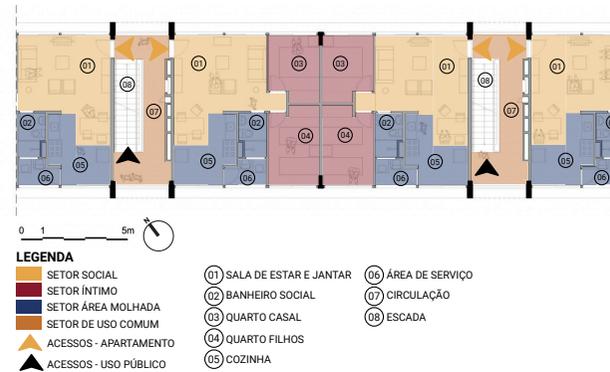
Planta baixa do bloco habitacional do tipo lâmina.
